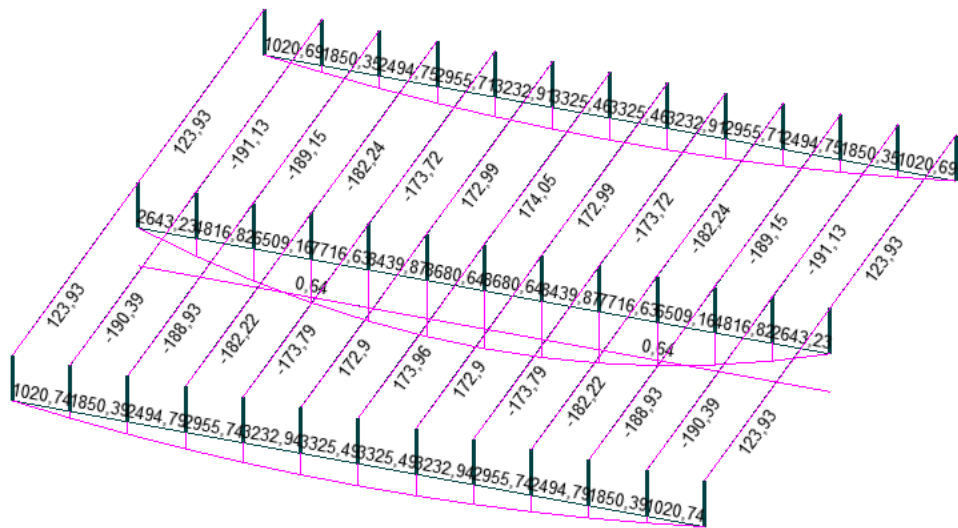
Балки перекрытия. Эпюры усилий M_y .
